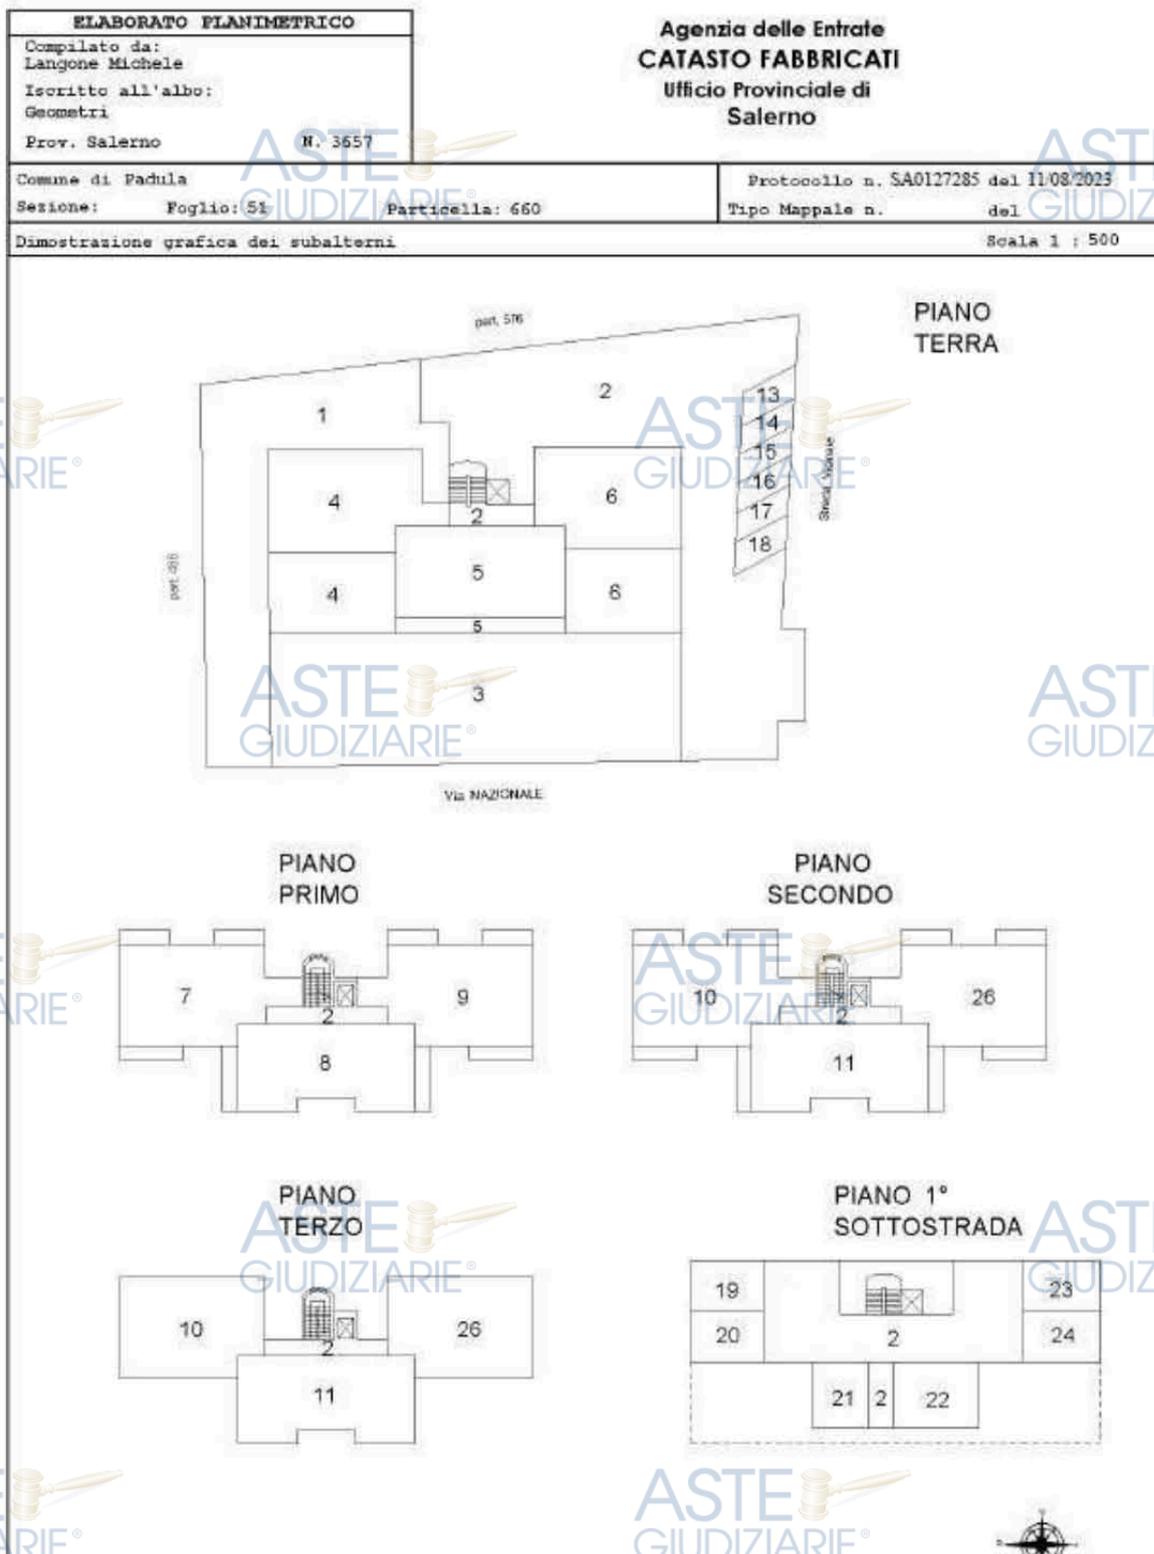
Elaborato Planimetrico F. 35 particella 660.
